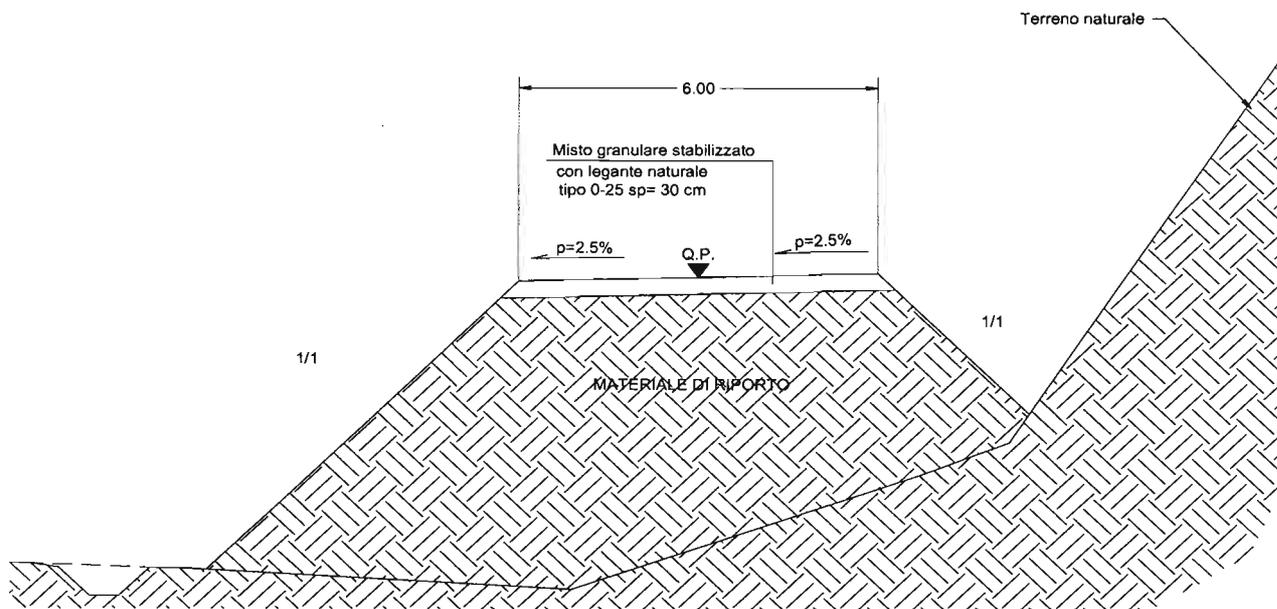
Sezione Tipo Strada Accesso Imbocco Scaleres Sud
